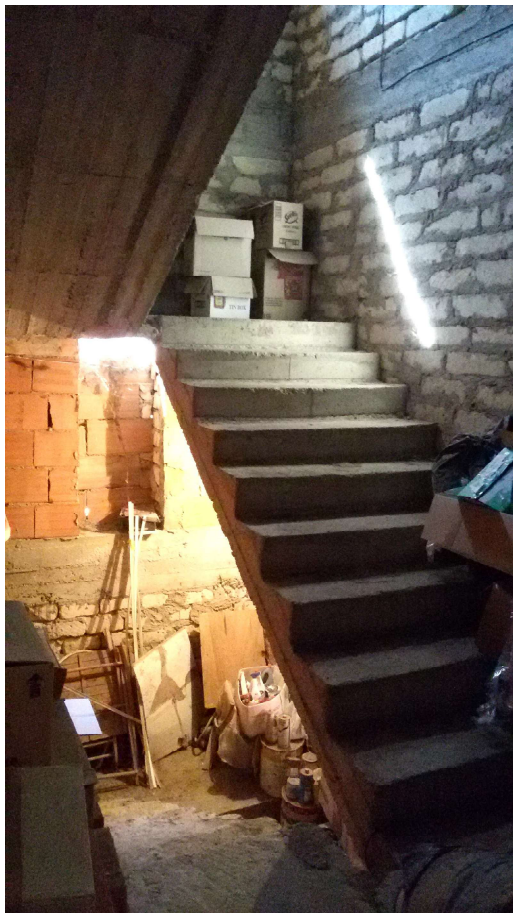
Rampa scala con arrivo al pianerottolo del P. 3°
